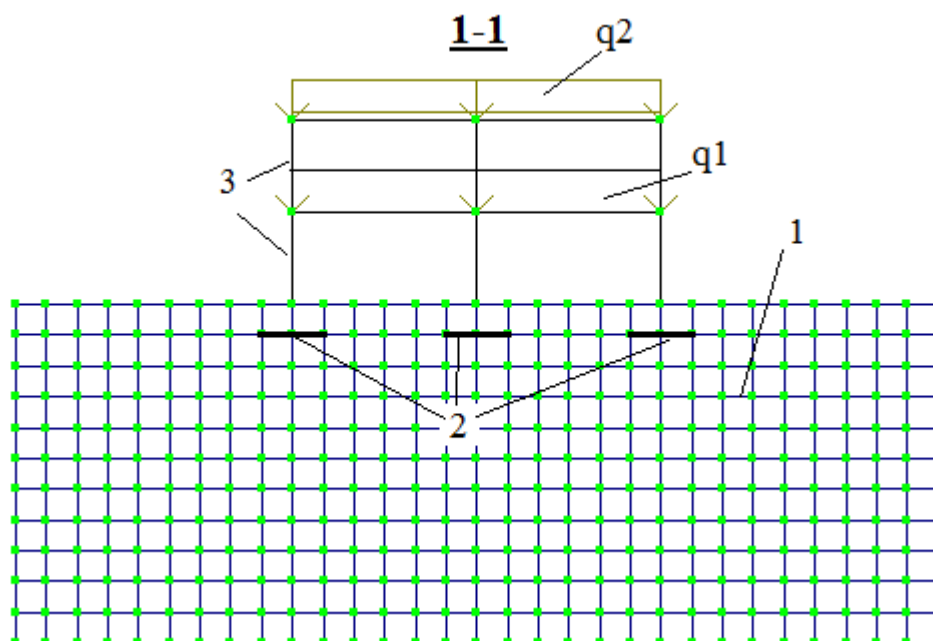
Розрахункова схема. Вихідний стан. Розріз по 1-1. 1 – основа; 2 – фундаменти; 3 – рамна конструкція
